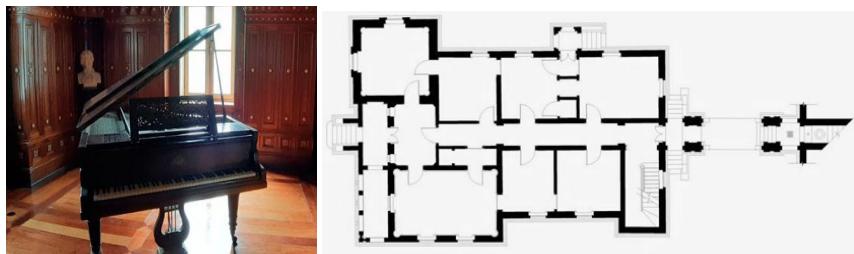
a) Sala de sarau da Villa; b) Planta da Villa.⁷
